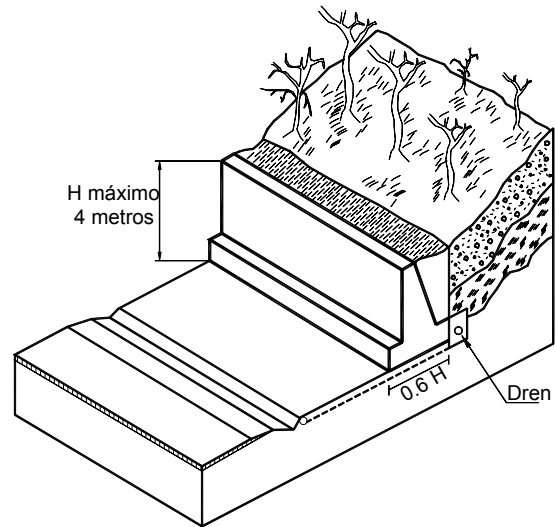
Tipos de muro de contención en concreto reforzado.
